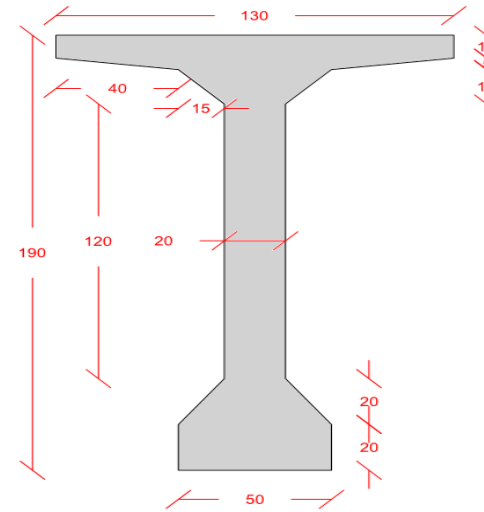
Détail de la poutre -variante 3-b (section mi-travée)
